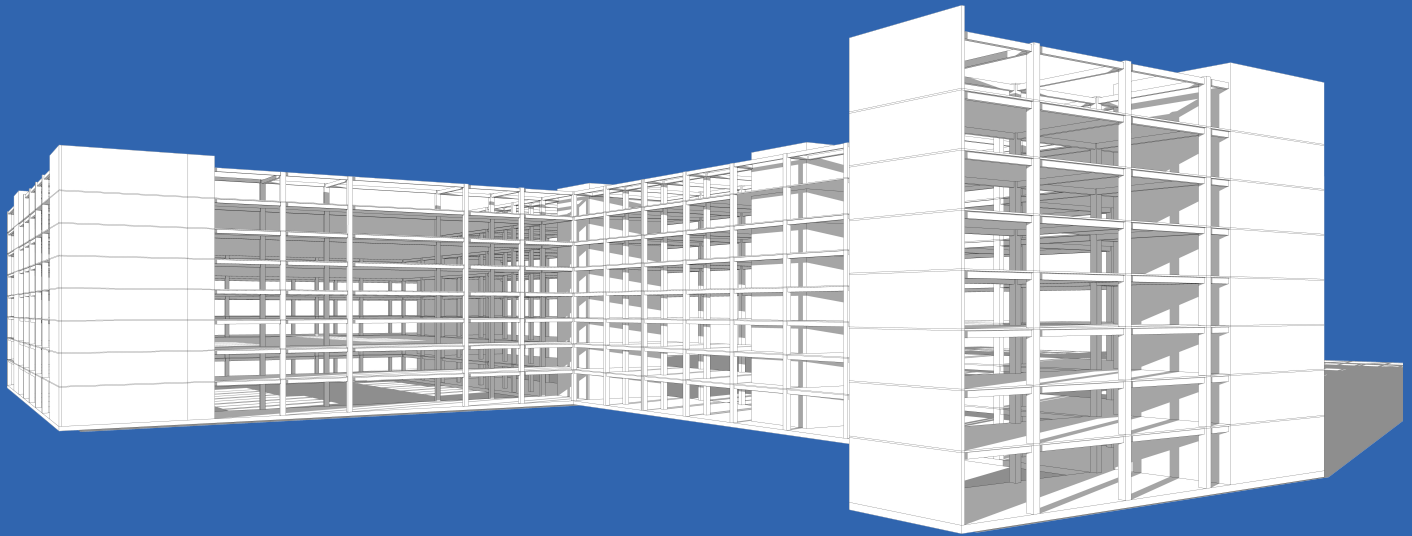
Vista esquemática de la estructura del proyecto utilizando marcos de hormigón rígido.
